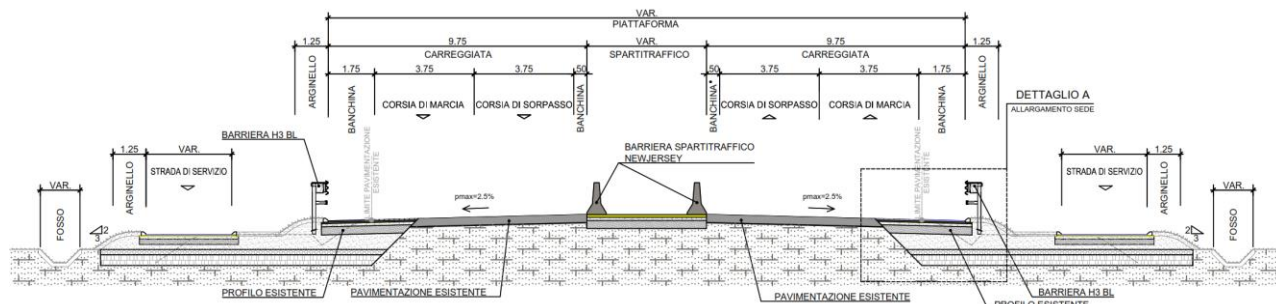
Sezione tipologica in rettilo con strada di servizio deviata
